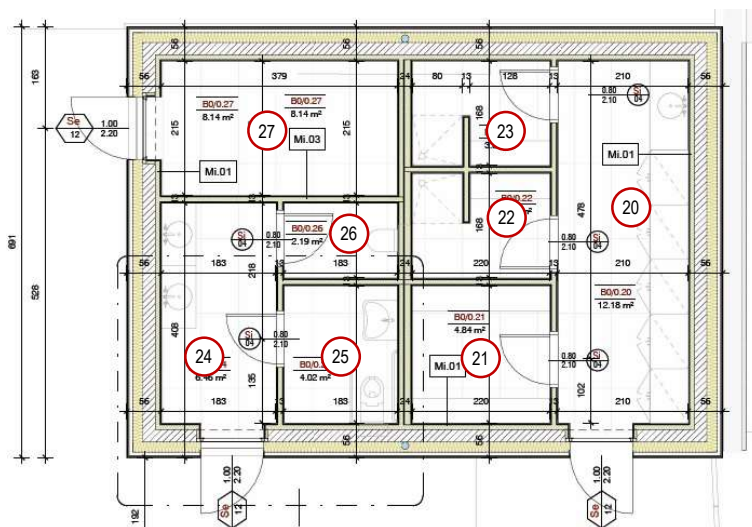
progetto esecutivo – edificio B - pianta piano terra – elaborato 310 – scala adattata
